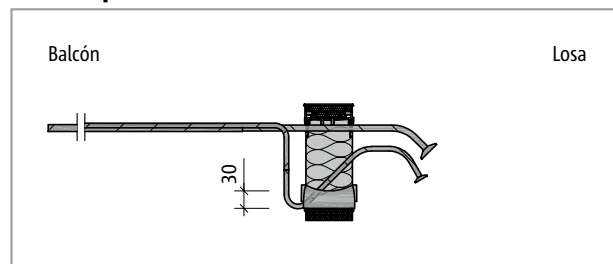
Schöck Isokorb® T tipo K-O-M1 hasta M3: Sección del producto
